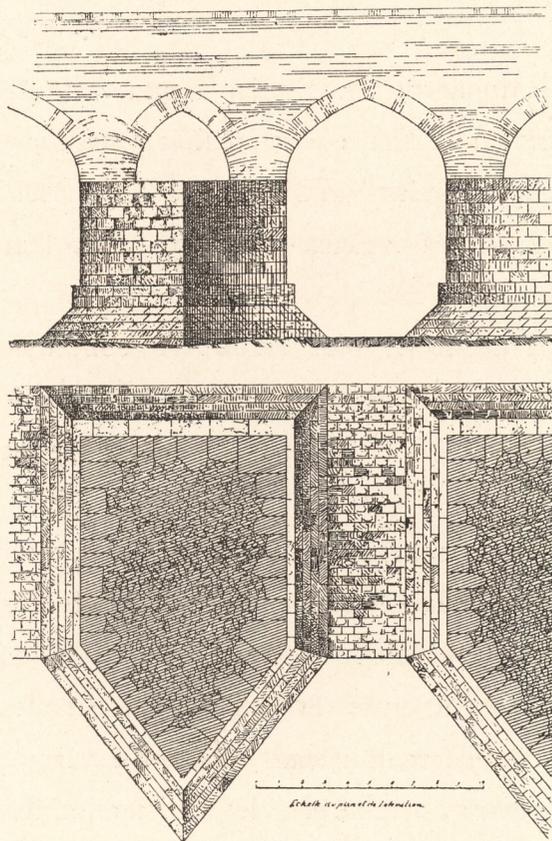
et 98. — Plan et élévation des piles sassanides du pont de Dizfoul.
